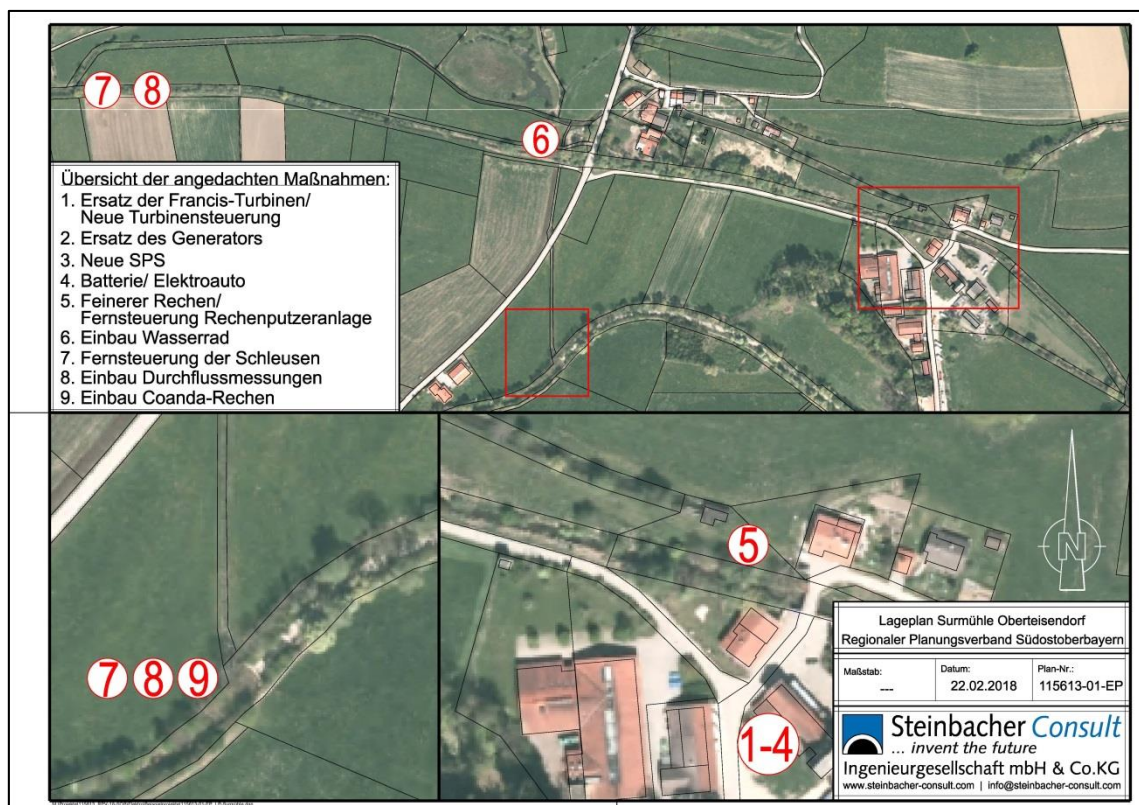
Lageplan der Surmühle mit den zu untersuchenden Maßnahmen
